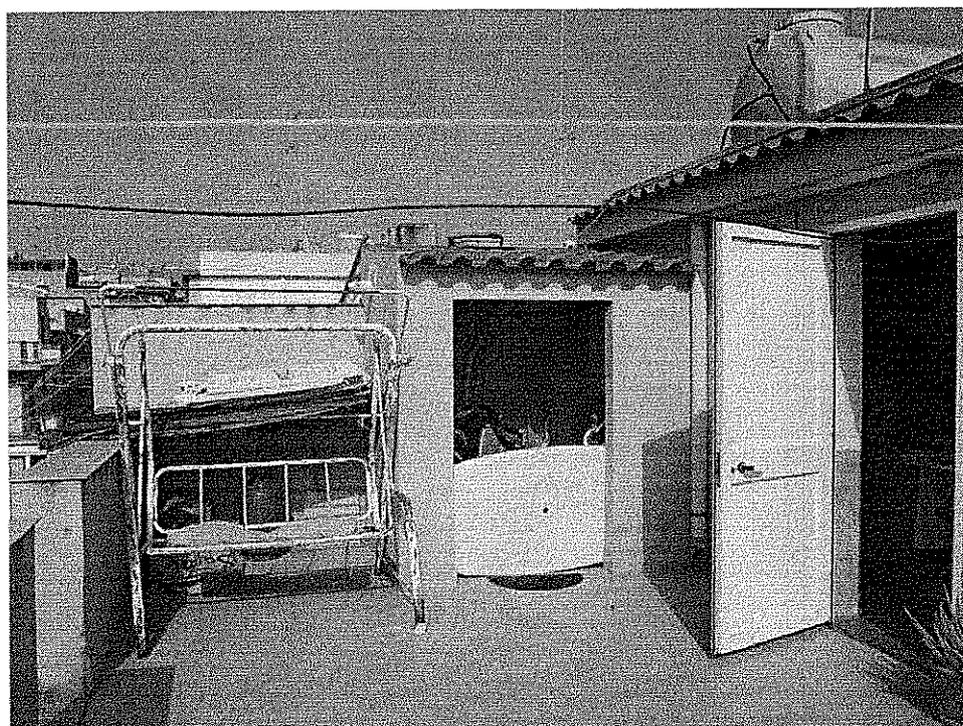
Fabbricato “1A” – Piano III – Terrazzo e locale-caldia
